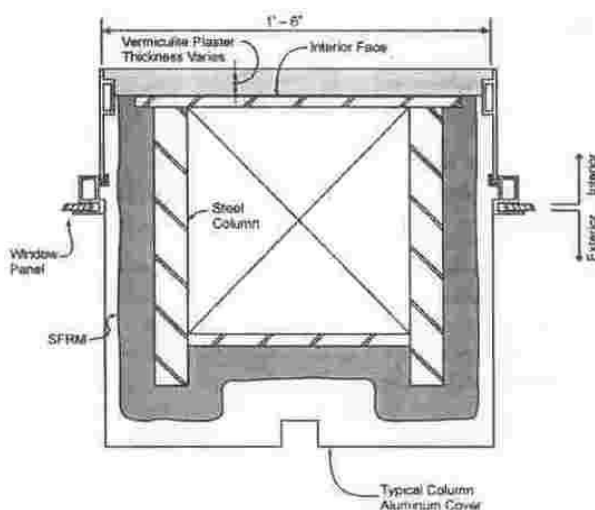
Огнезащита стальных колонн наружной оболочки высотных башен ВТЦ
